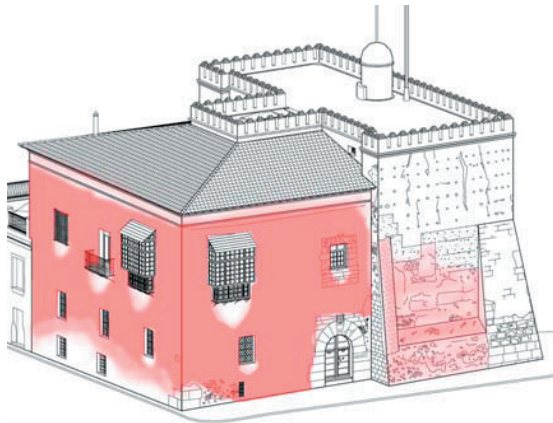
Ensuciamiento en fachadas Norte y Este.
